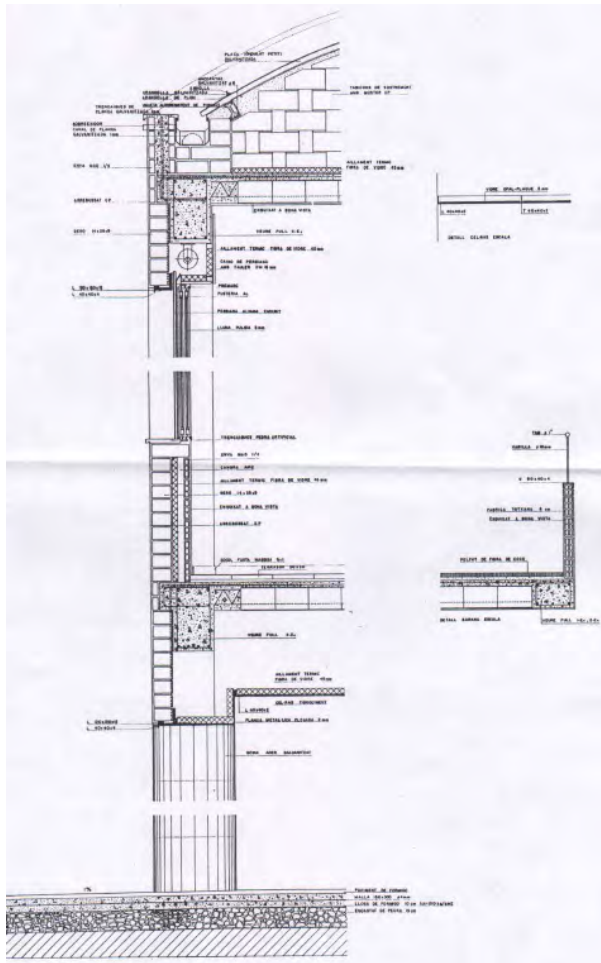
Secció transversal de façana de l'edifici del c/Biscaia, Badalona
